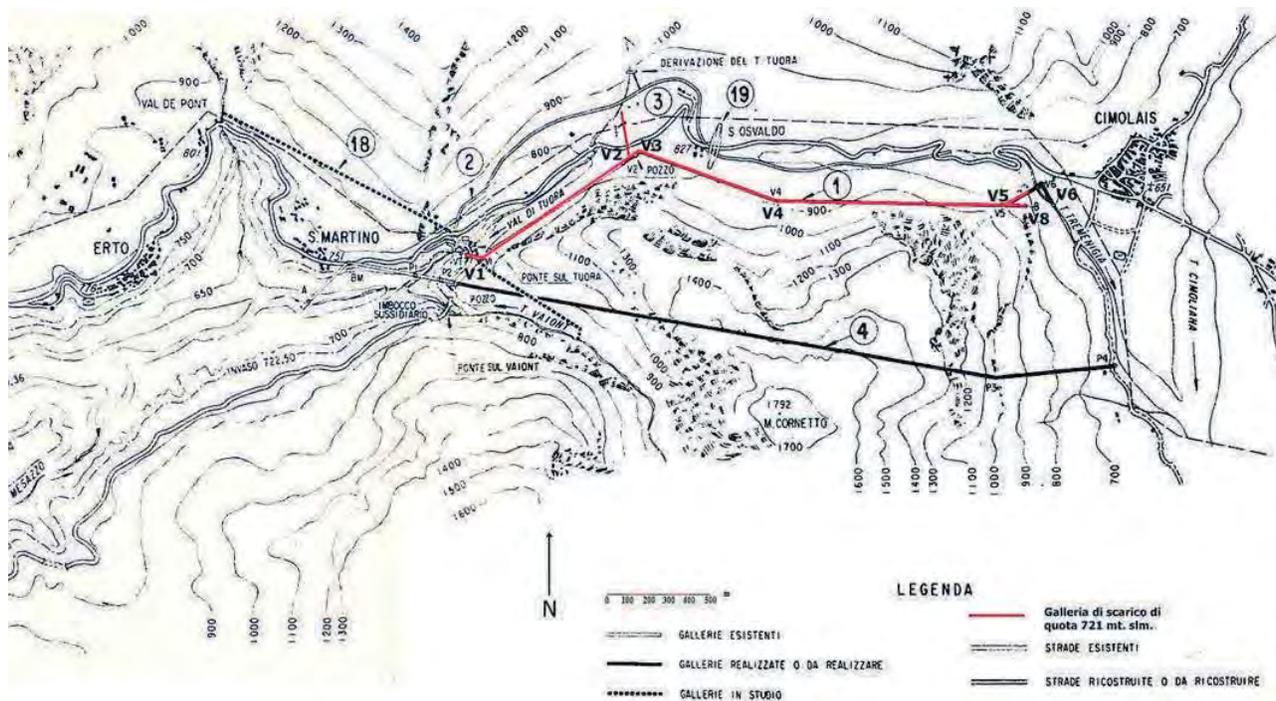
Planimetria ENEL dello stato delle gallerie di scarico orientali ad inizio del 1964; evidenziato in rosso il tunnel di quota 721 m s.l.m. esplorato (archivio Progetto Dighe).
